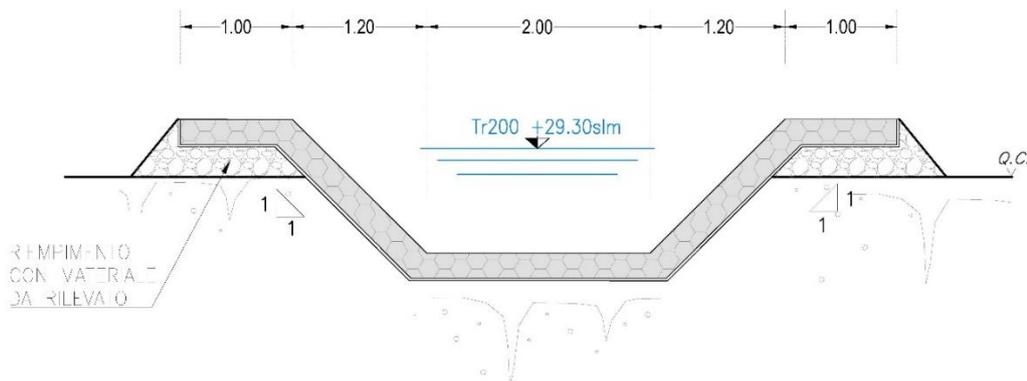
Sezione tipo del canale rivestito in materassi tipo reno.
